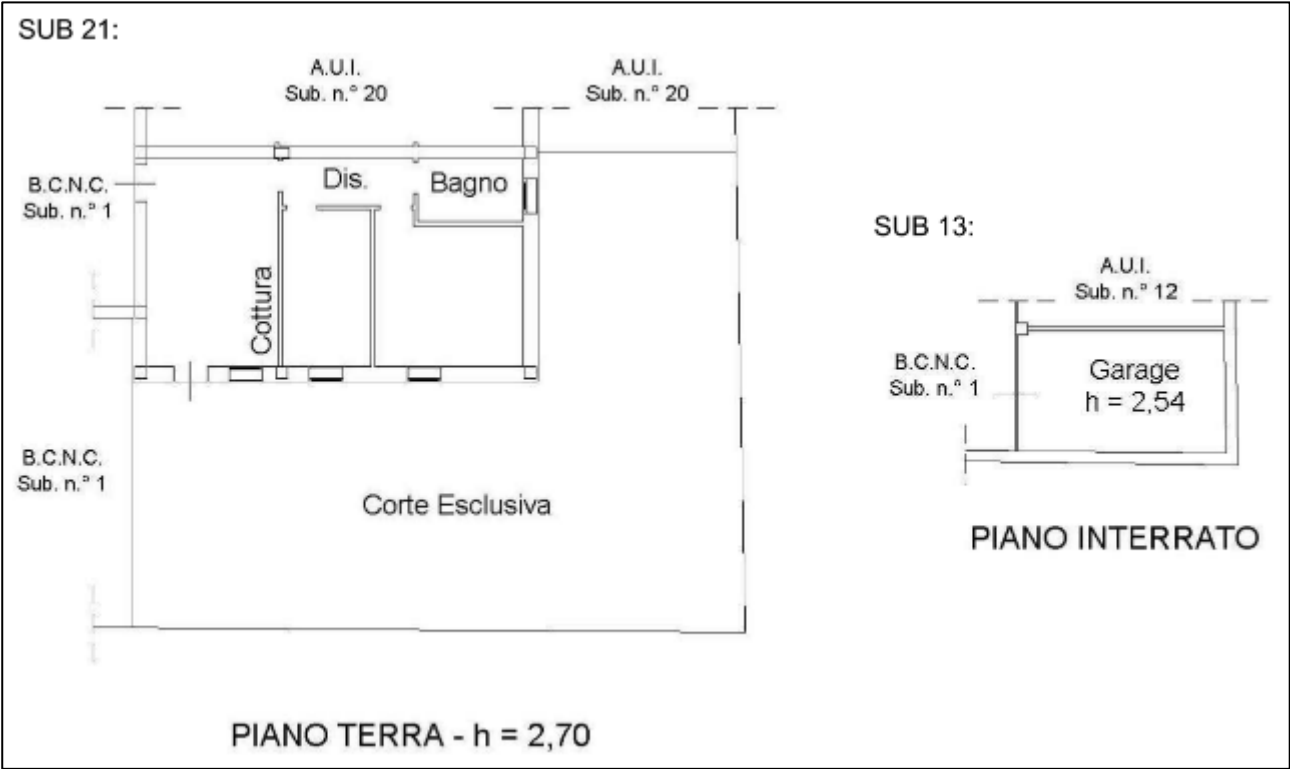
Planimetria catastale (appartamento sub 21 e garage sub 13)
